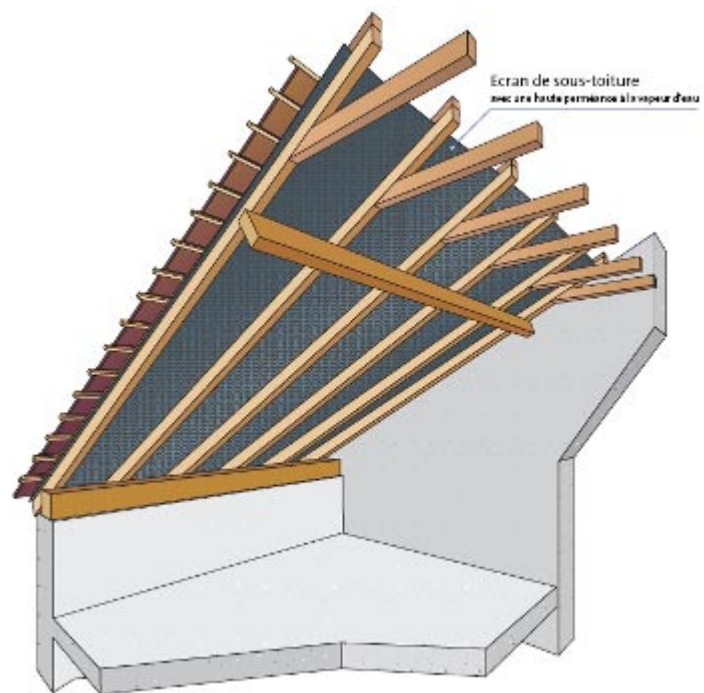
Écran de sous-toiture en place en charpente traditionnelle
